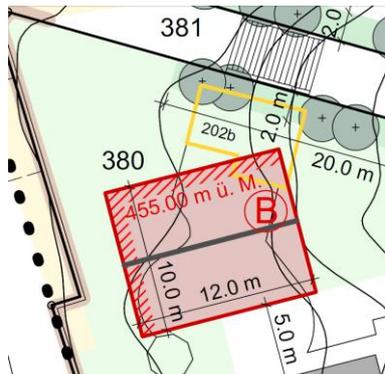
Bebauungsplan Dorfkern Ost, Stand öff. Auflage
